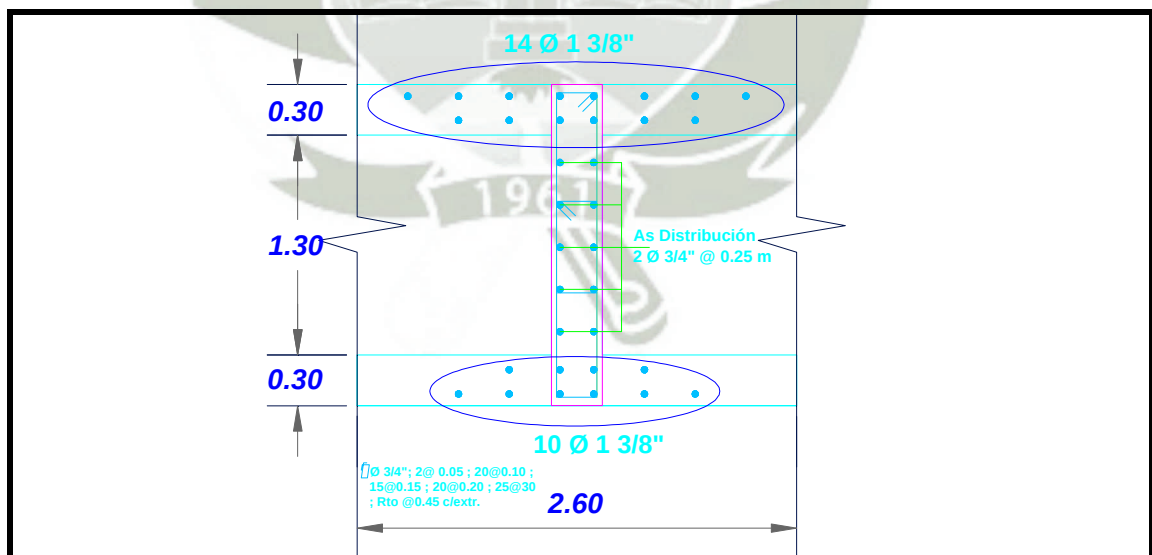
Diseño en Concreto Armado – Viga Interior del Tablero de Puente
